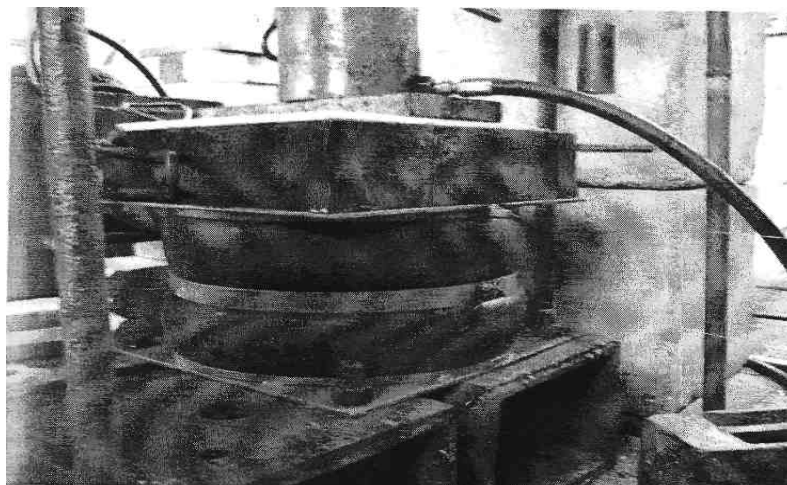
Испытания РСБ на сжатие на специальном стенде
